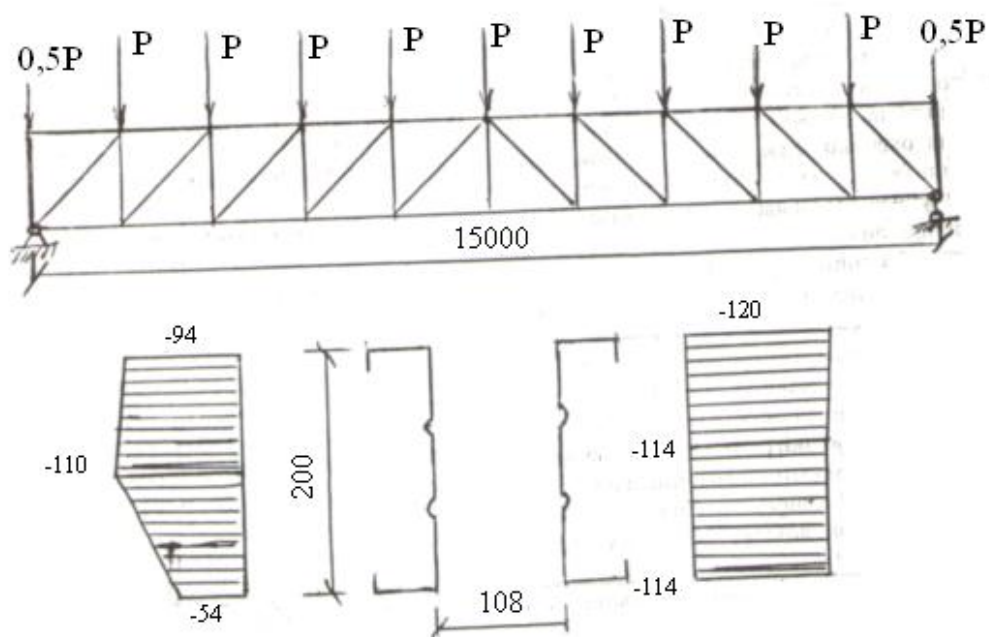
Схема фермы и эпюра нормальных напряжений в сечении верхнего пояса.
